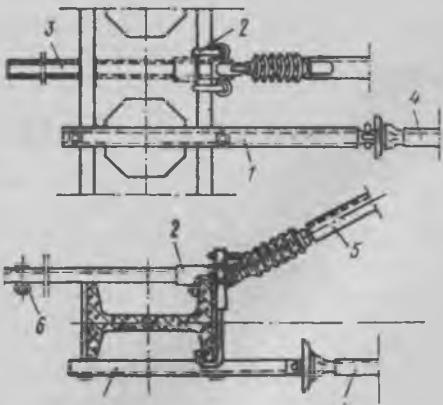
Установка направляющего приспособления на опоре типа ЖБД:
